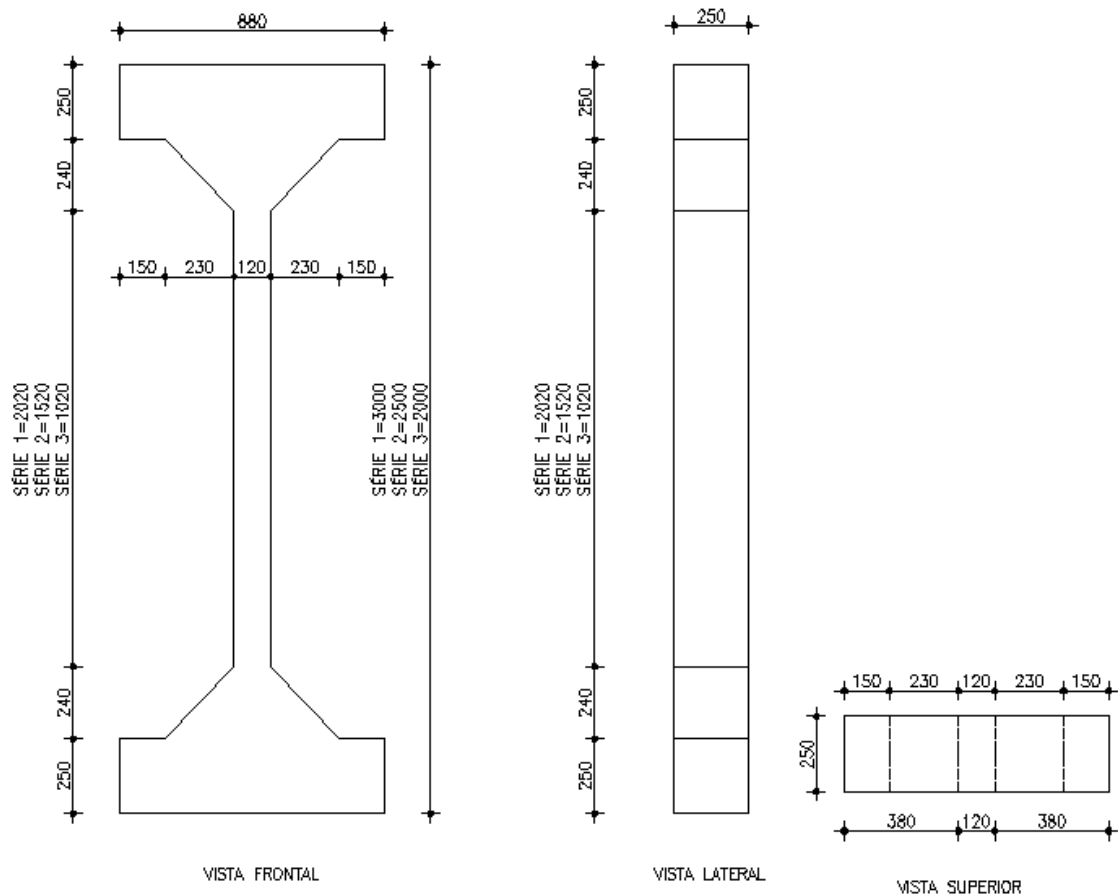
Dimensões dos pilares ensaiados (mm)
